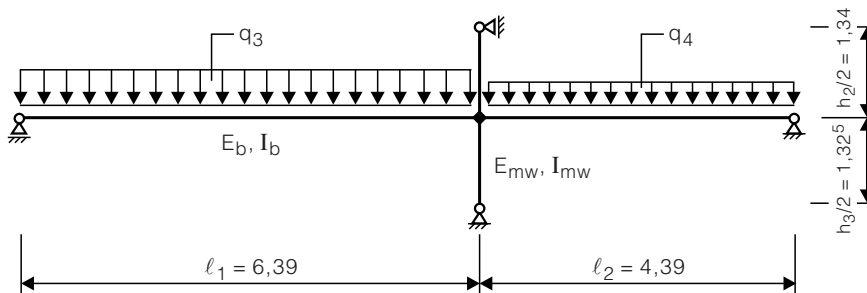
Teilsystem D nach Anhang A, Abschnitt 10.1
